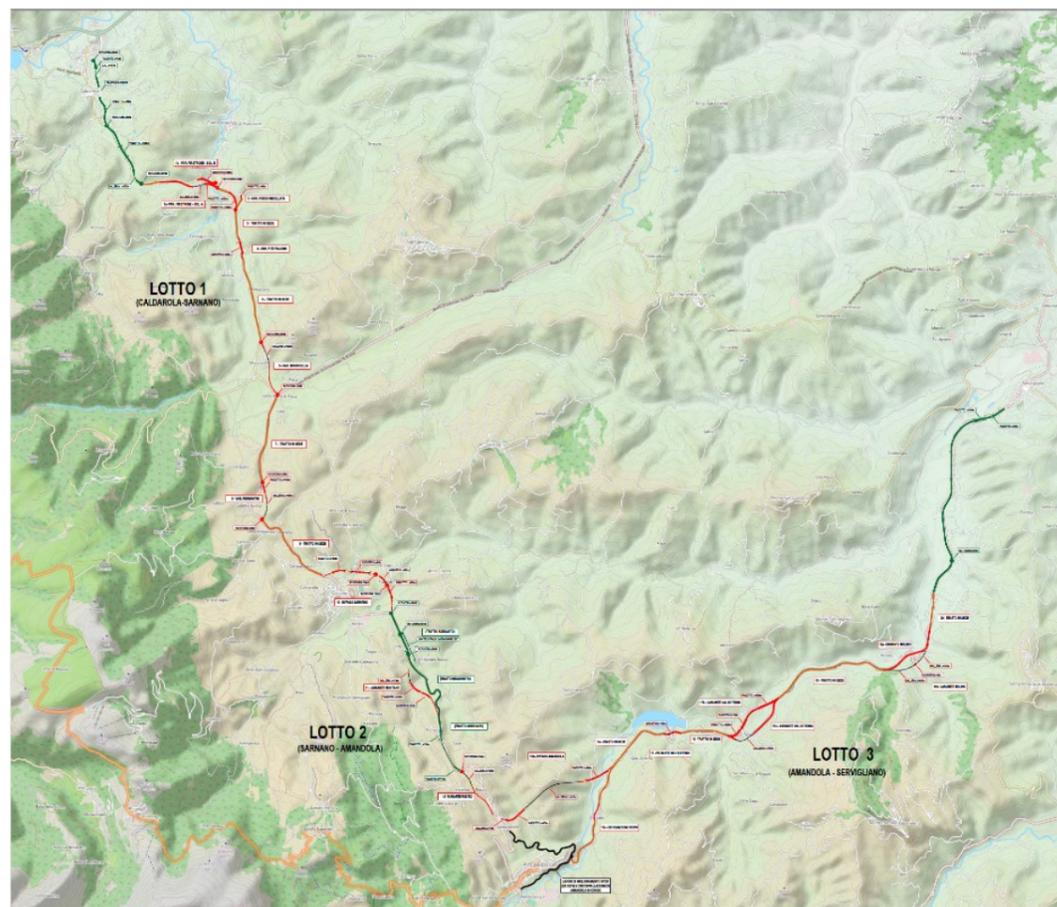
Individuazione interventi _ Lotto 1, Lotto 2, Lotto 3
